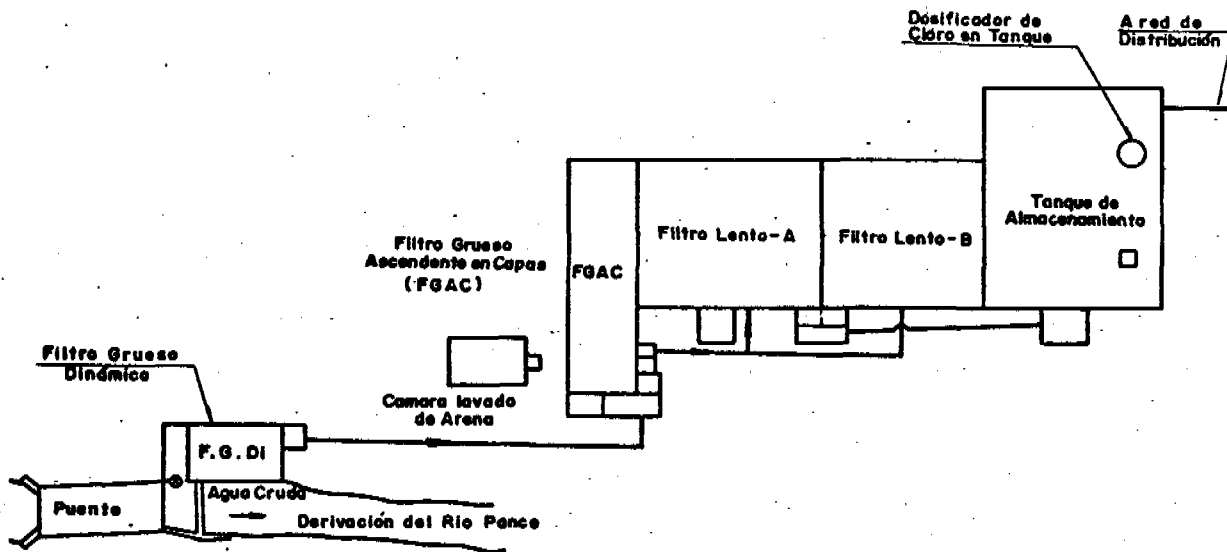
Planta de tratamiento Derivación A. Rio Pance. (CINARA, 1987)
